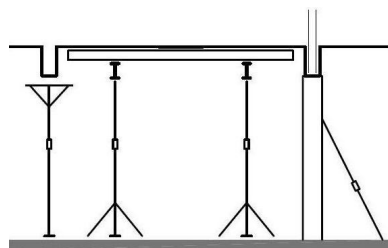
figura esquemática dos painéis da faixa de reescoramento das lajes
